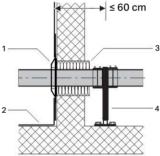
Traversée de mur avec étanchéité contre l'humidité
